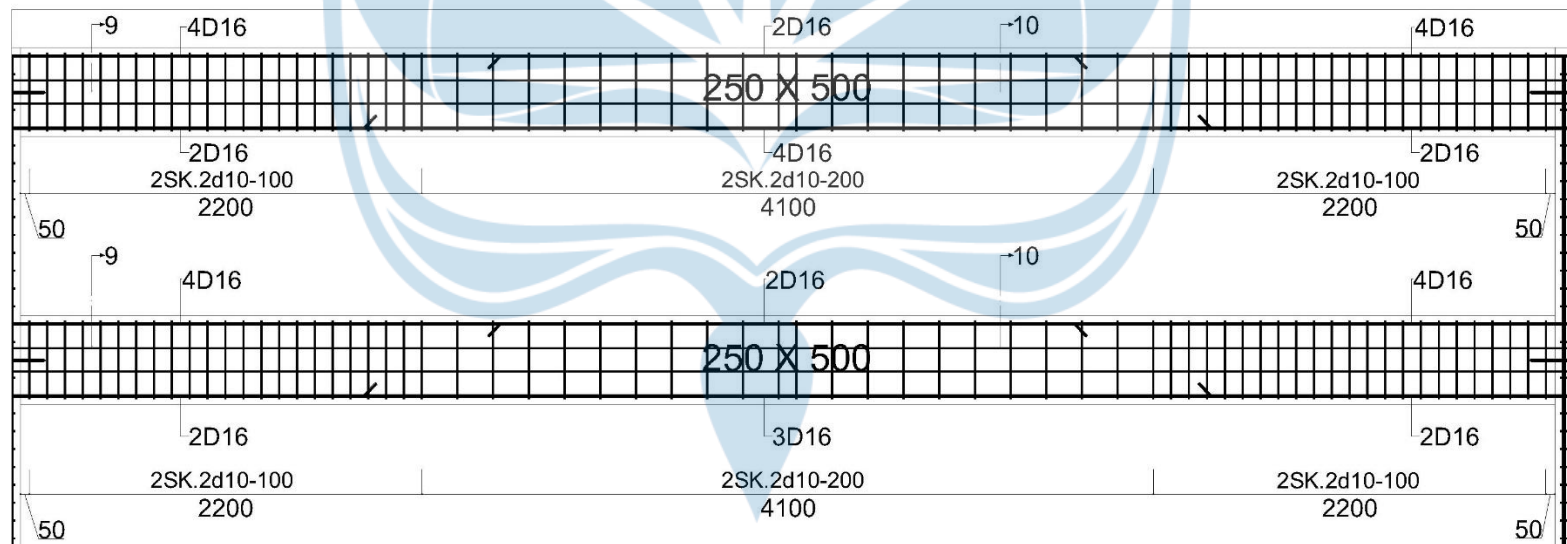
Detail penulangan kolom-balok lantai 2 dan 3 as A-B
